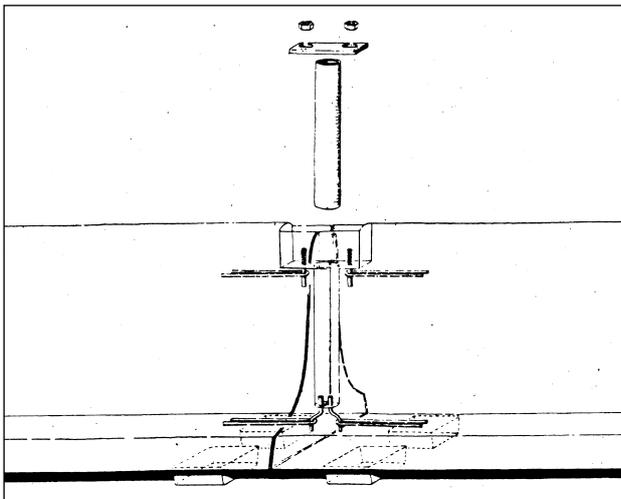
sistema di assemblaggio degli elementi Tric-Bloc
